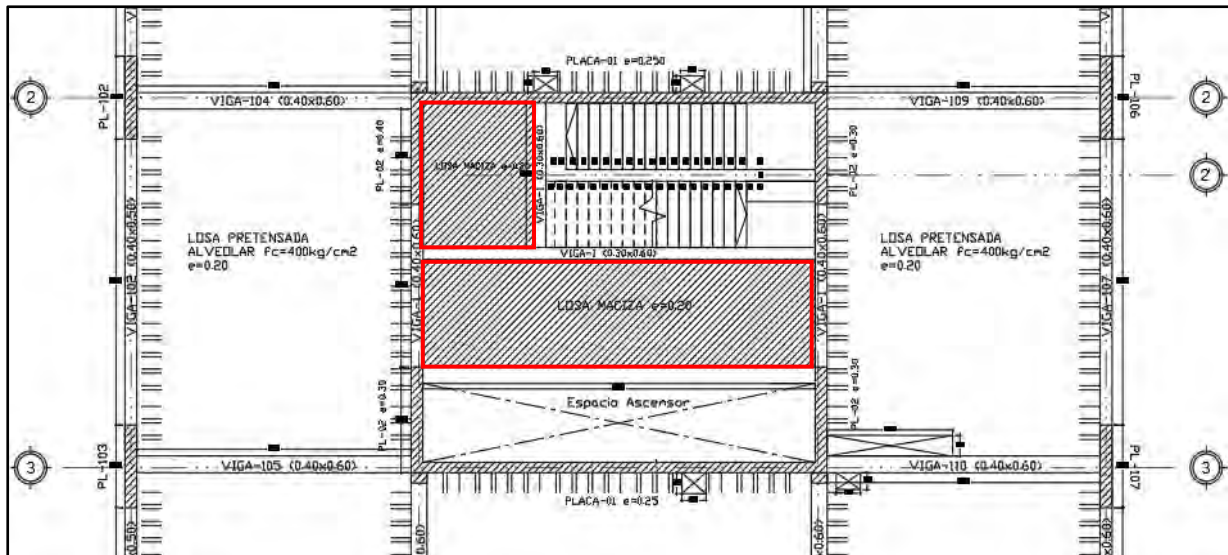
Ubicación de las losas macizas sobre el plano de techo piso típico (Fuente propia)
